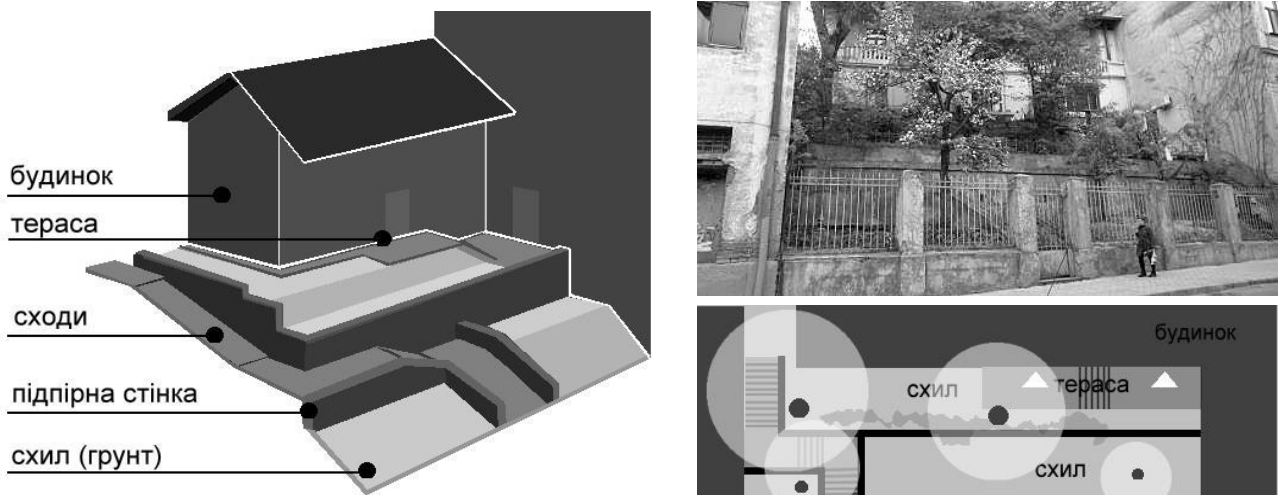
Дворик на схилі, буд.№3: схема планування рельєфу; фотофіксація; план-схема
